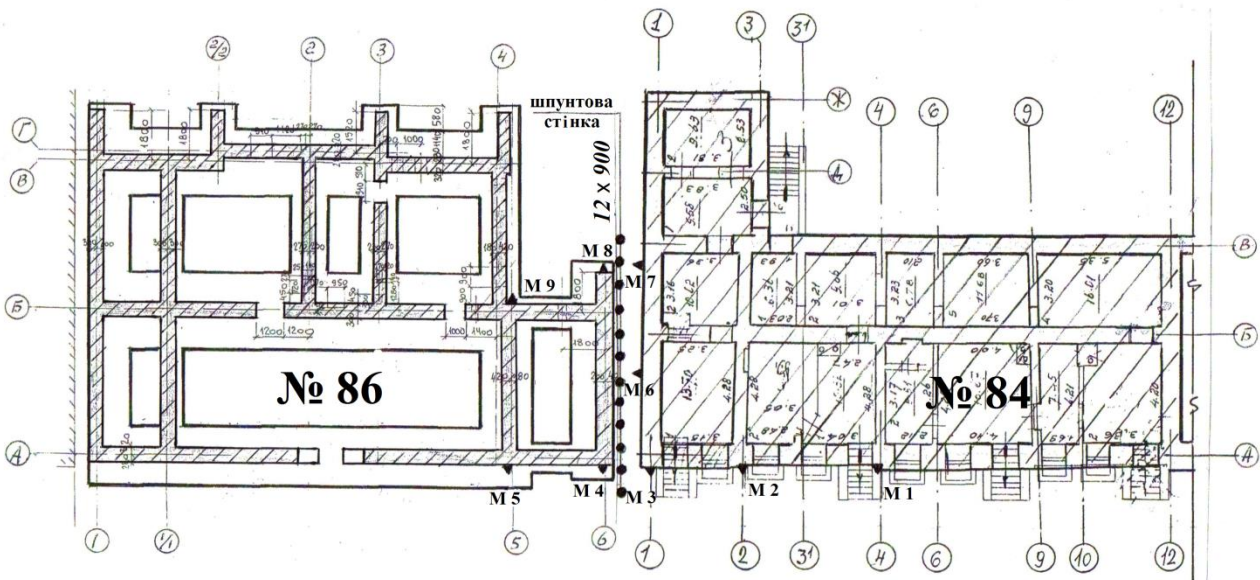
Суміщені план-схеми будівель з розташуванням стінних марок і шпунтової розділової стінки.
